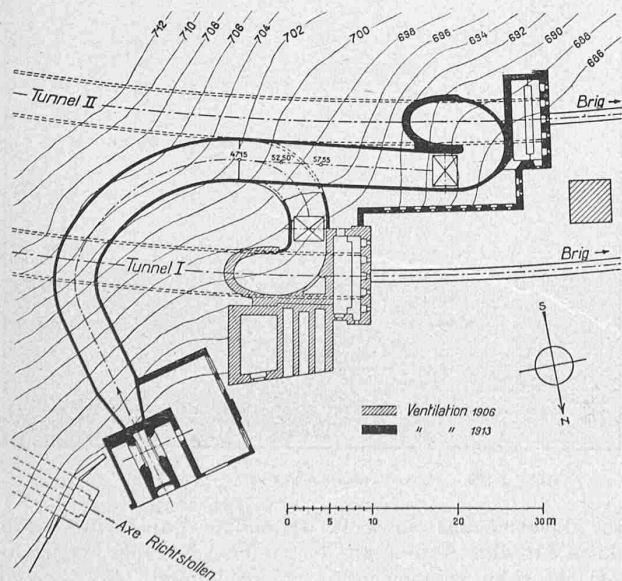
Lageplan der Simplon-Ventilations-Anlage. — 1 : 800.
